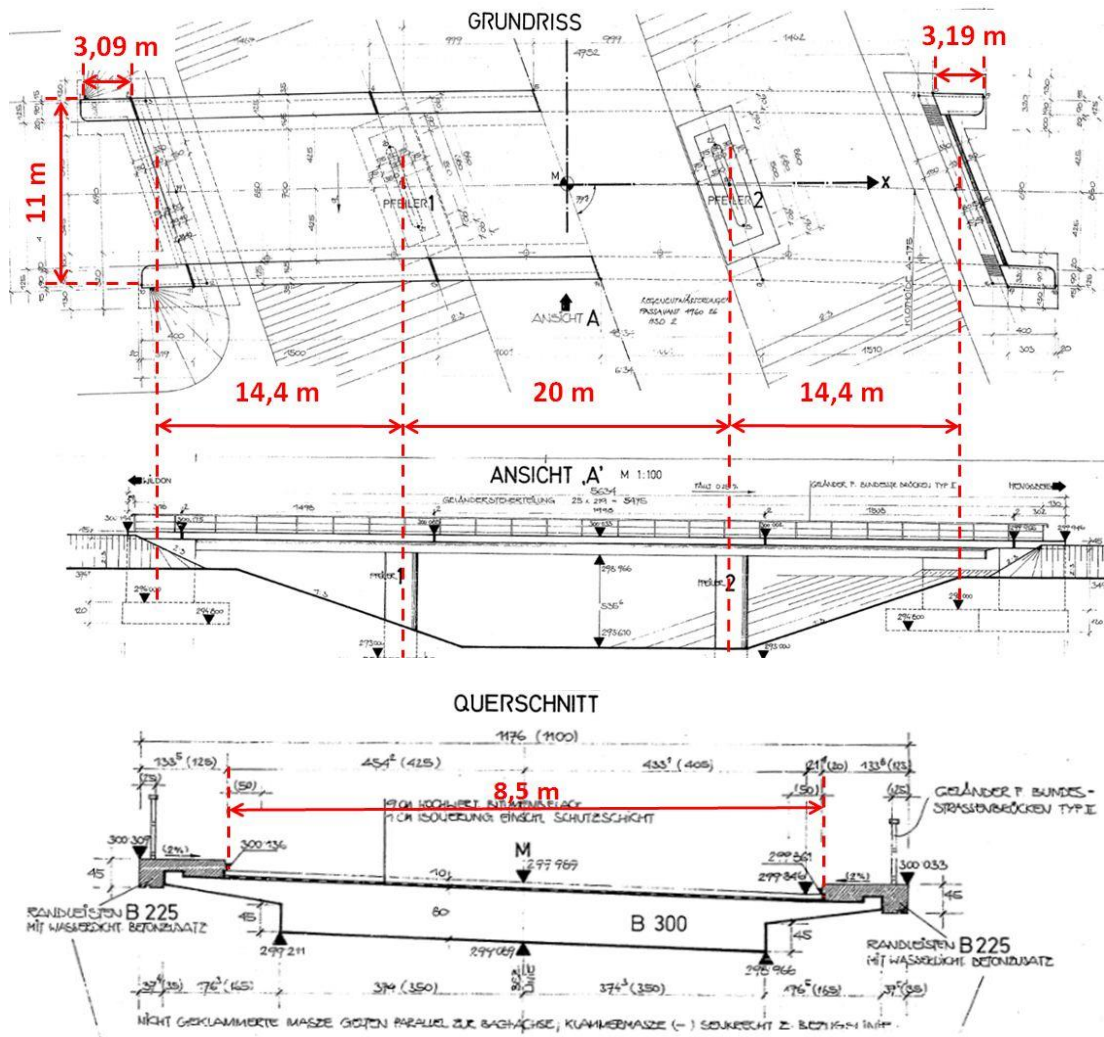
Kainachbrücke Kehlberg: Grundriss, Längsschnitt und Regelquerschnitt
